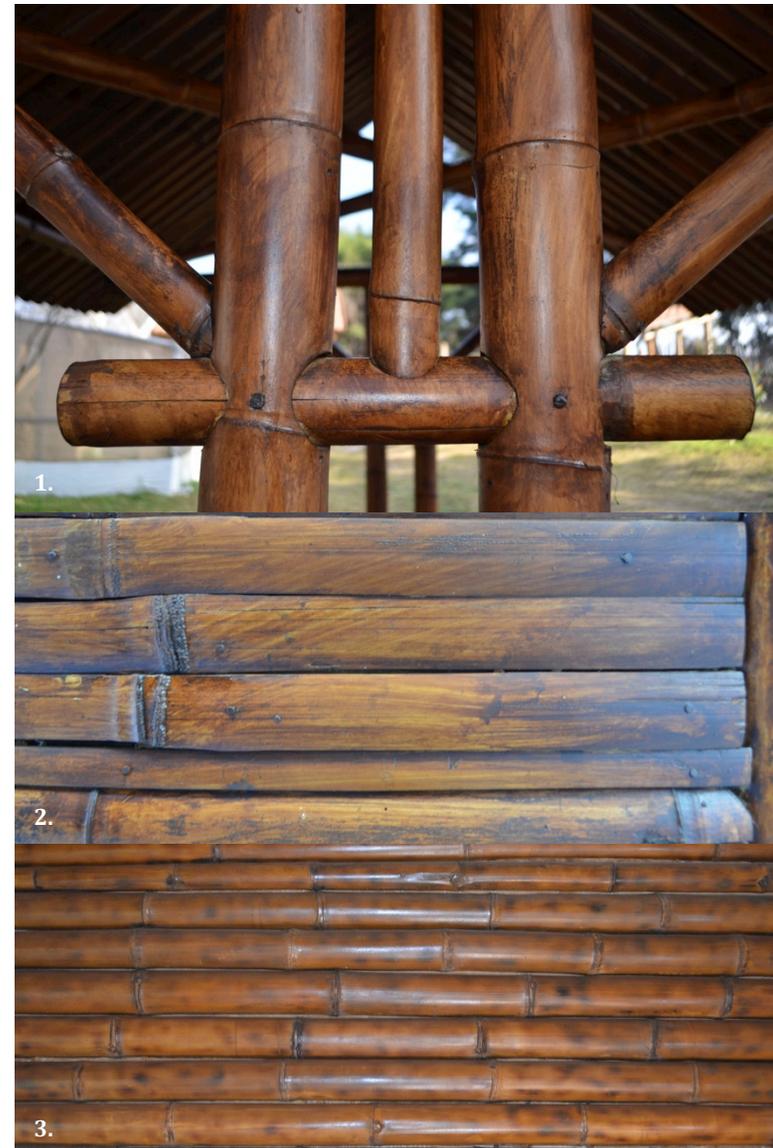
1- Detalle de unión en kiosko, vara con tinte y barniz. 2-Detalle de varas con quemado claro, tinte y barniz. 3- Detalle de varas quemadas recubiertas solo con barniz. Fuente: propia
